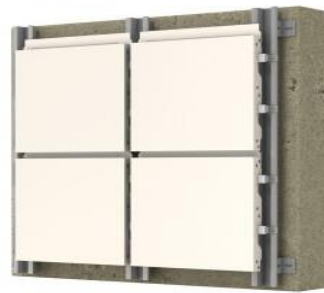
système de panneaux en aluminium (source: ma.exlabesa.com)
